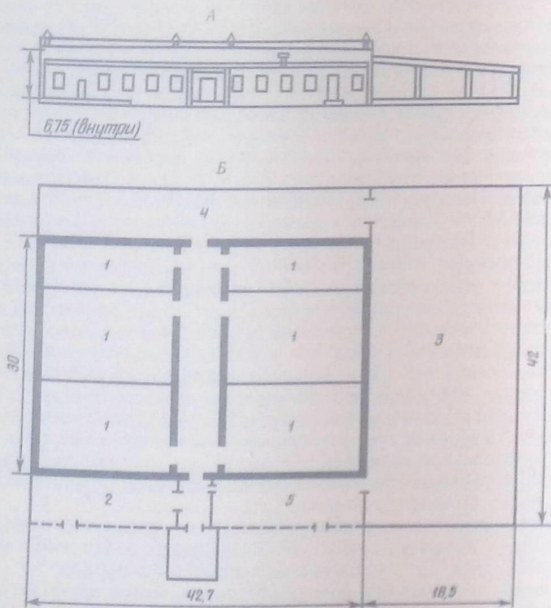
Схема плодохранилища с помещением товарной обработки плодов (А — фасад, Б — план):
